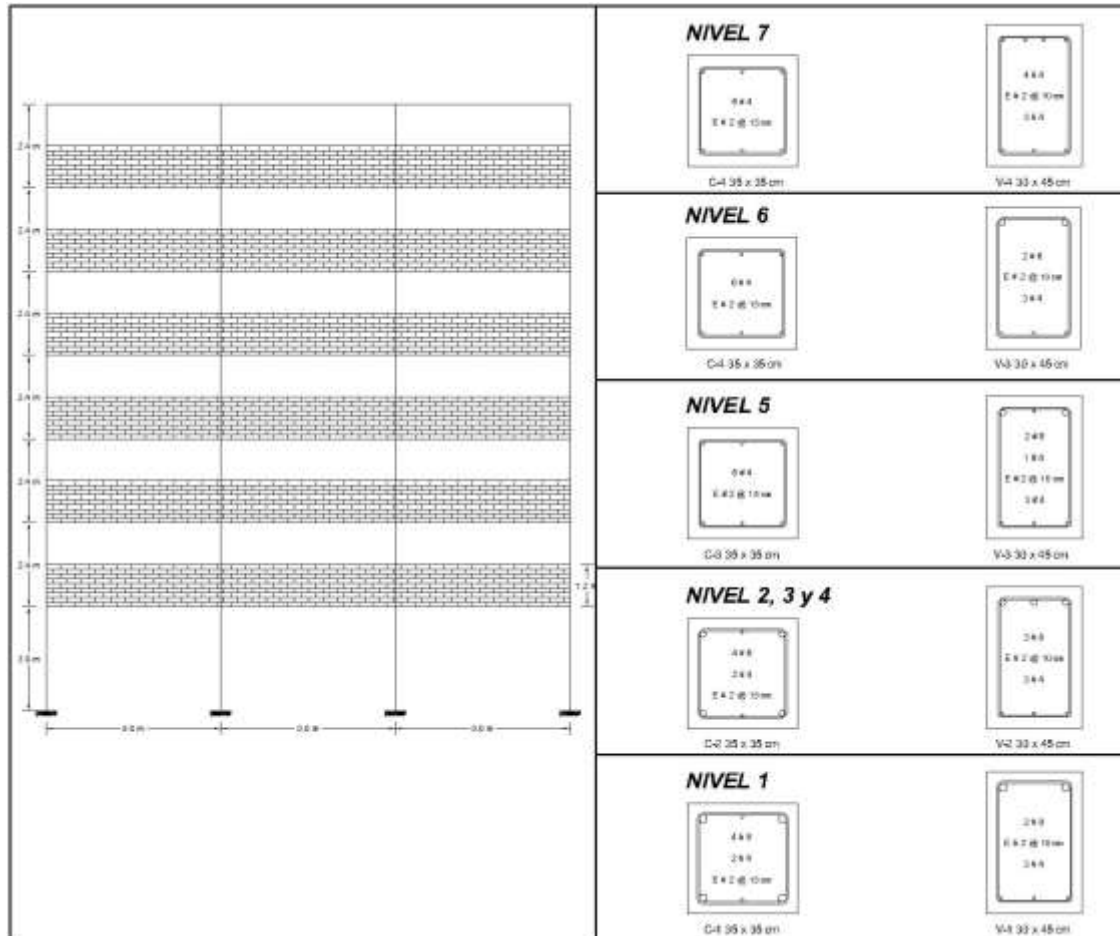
Armado de vigas y columnas para MCR de 7 con ML diseñadas con el RCDF-1977 (DDF, 1977)
